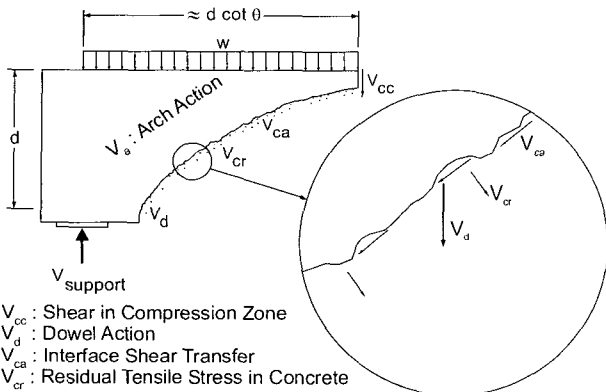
Shear transfer of cracked reinforced concrete beams without shear reinforcement
